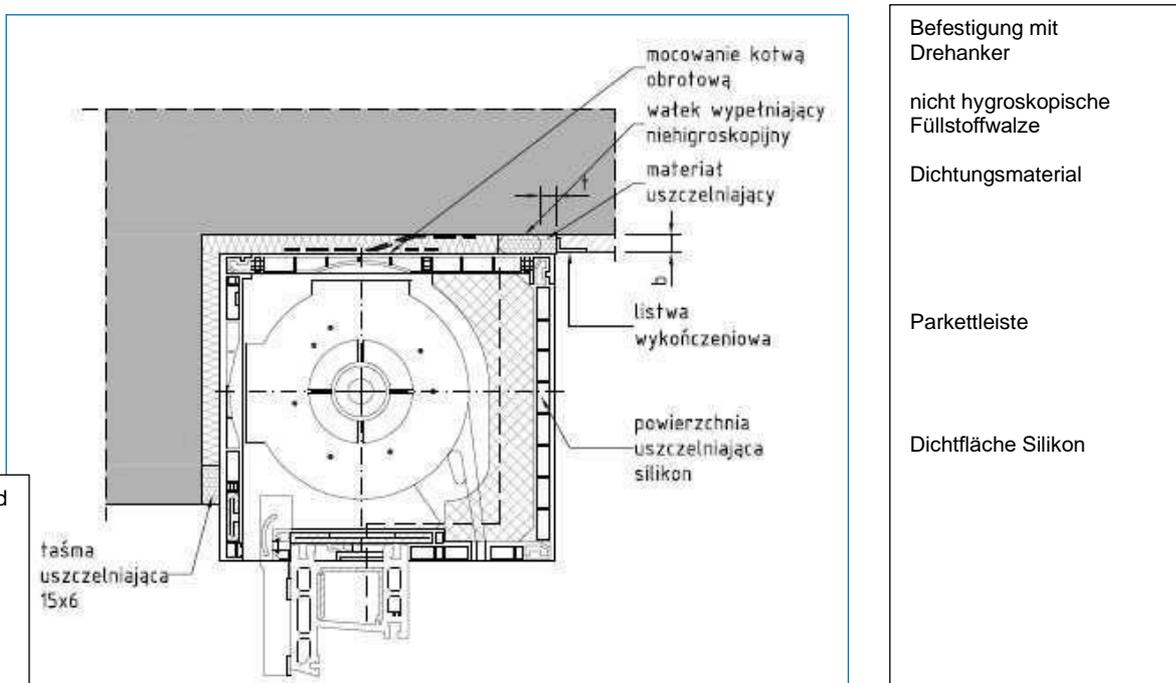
Verbindung aus Fenster und Rollladenkasten in Leibung mit Anschlag eingebaut
